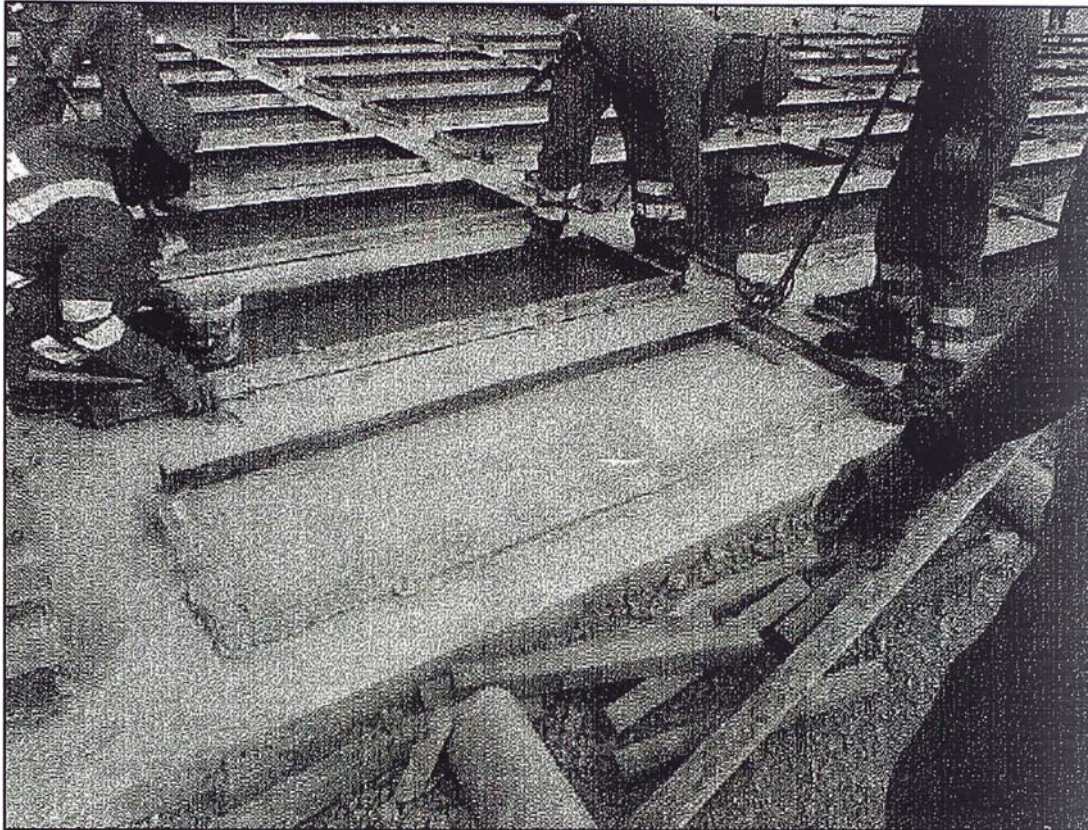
Fabricación de paneles – Aplicación de desmoldante
